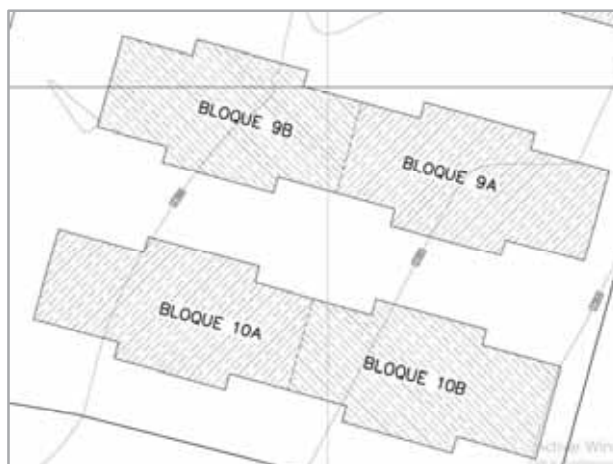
Plano en planta del bloque en estudio. (Elaboración propia).
